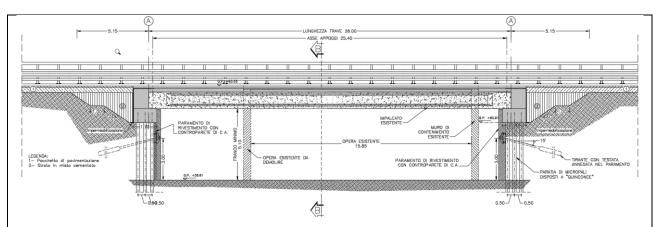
Intervento di adeguamento del viadotto VI10U nella soluzione di progetto approvato
